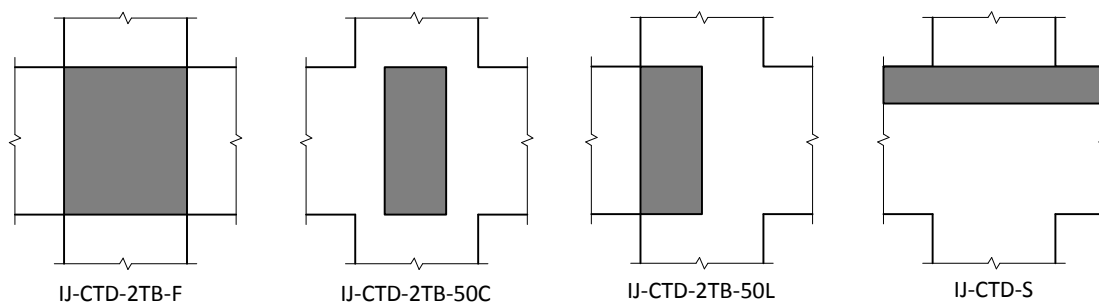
Elementos transversais na ligação viga-pilar interior.
